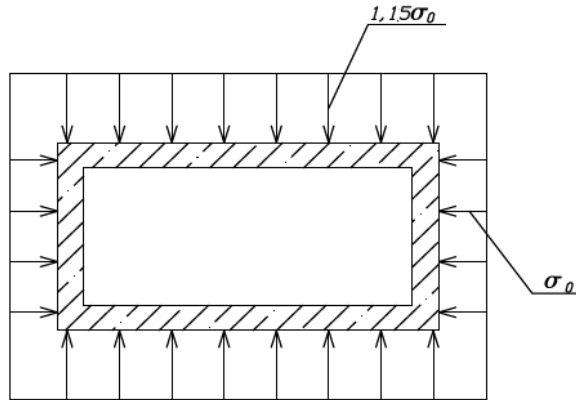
Схема к расчету стен опускного колодца на изгиб в поперечном сечении
